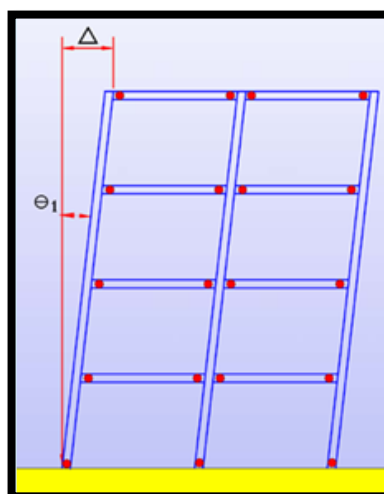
Presencia de rótulas plásticas en vigas y no en columnas
